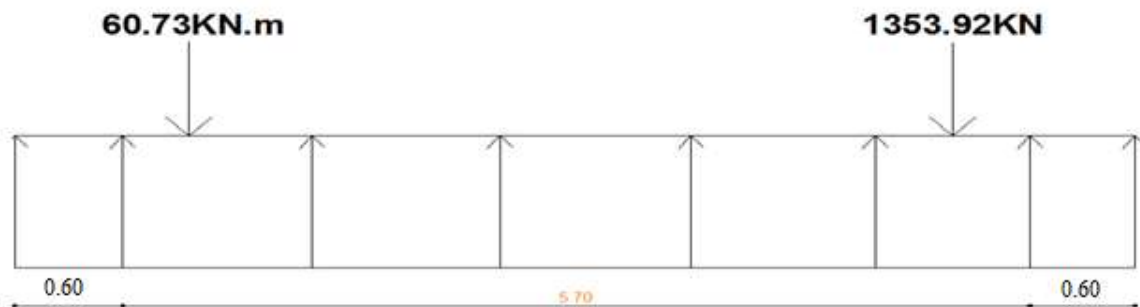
Semelle filante sous 2 poteaux et un voile.
